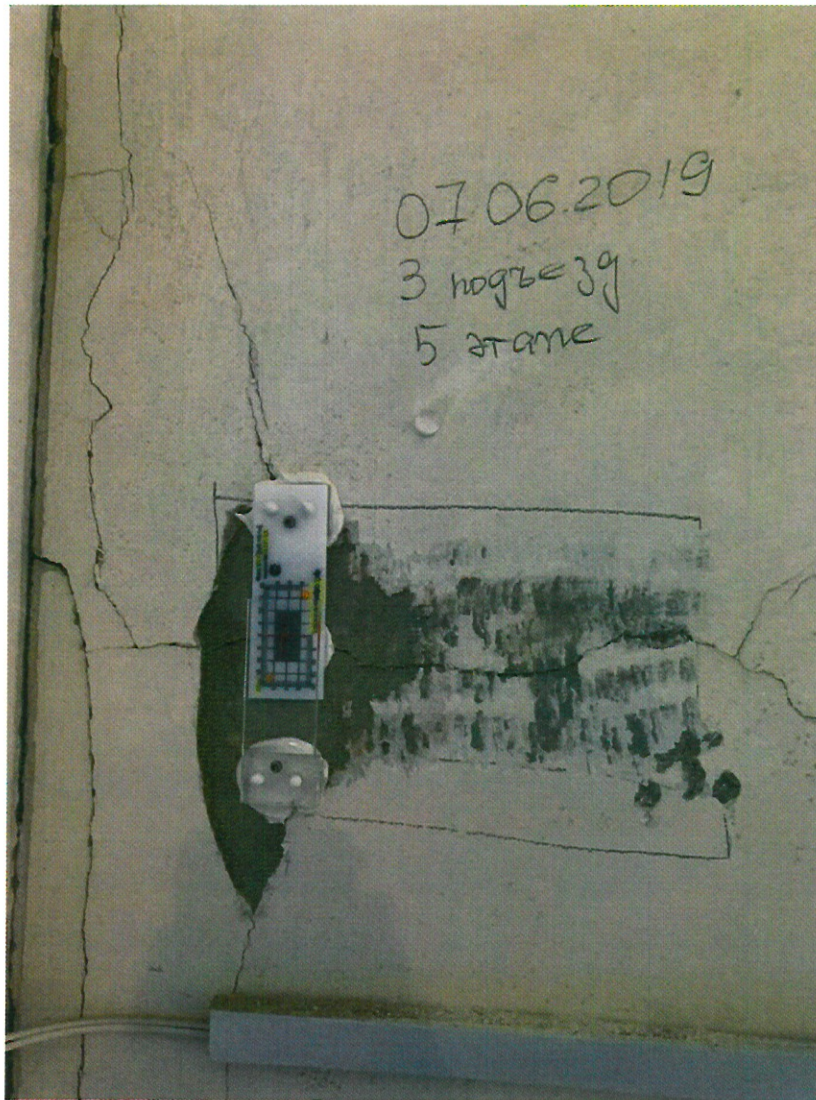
Установка маяка в здании на ул. Советская, д. 24 (3 подъезд, между 4 и 5 эт.). Трещина в поверхностном бетонном слое стеновой панели
